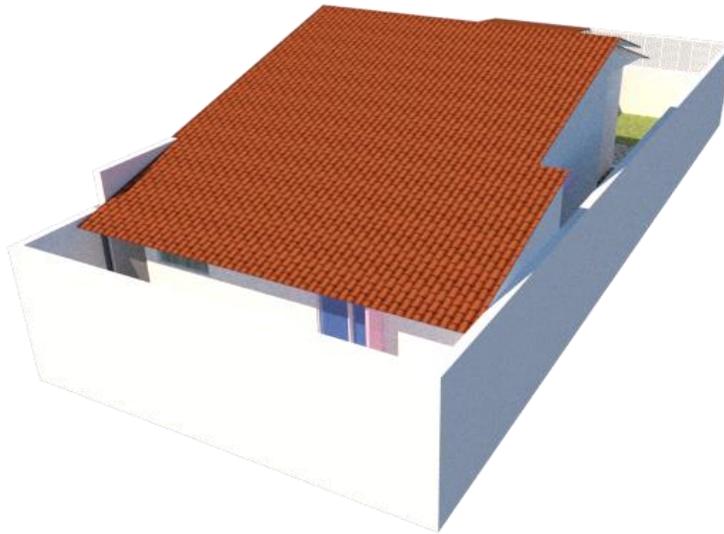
Proposta espelhada orientada à Nordeste - Fachada posterior
